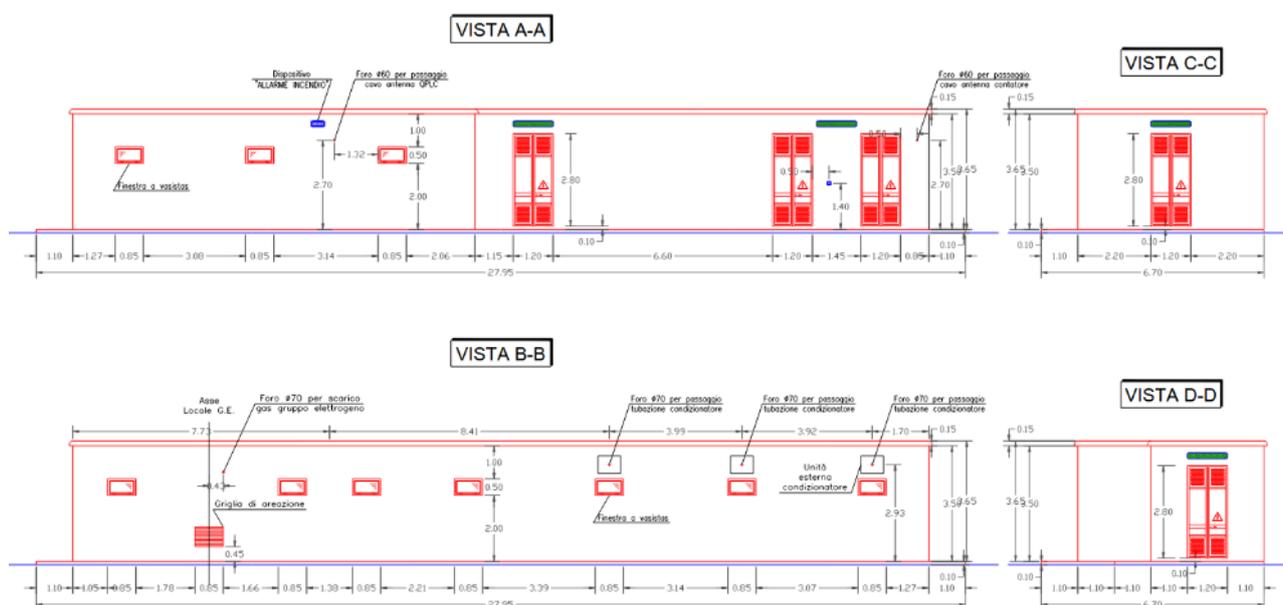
Stazione elettrica di utenza, da elaborati di progetto dell'Ing. Vergelli.
